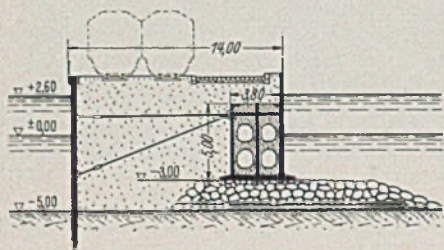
Querschnitt C—D durch die Zugangsmole (Ausschreibungsentwurf).
